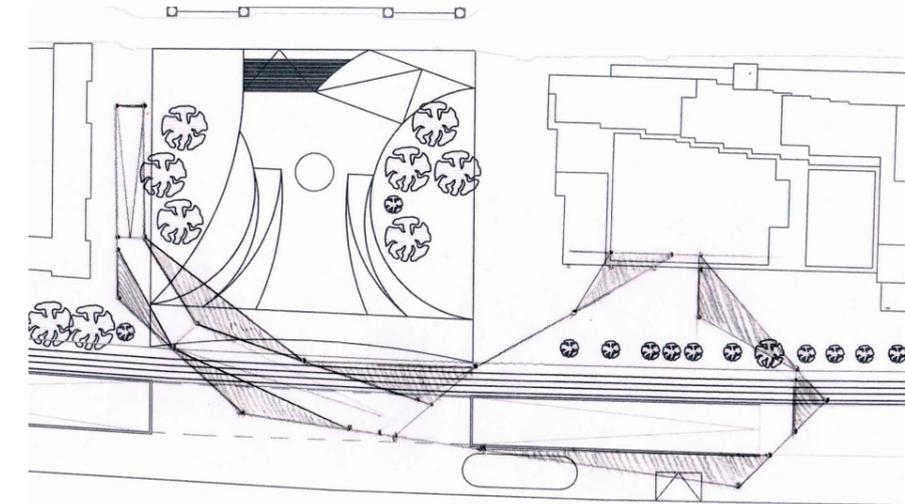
Entwurfsskizze 2. Vorentwurf, Erschliessungsrampe mit Plattform
